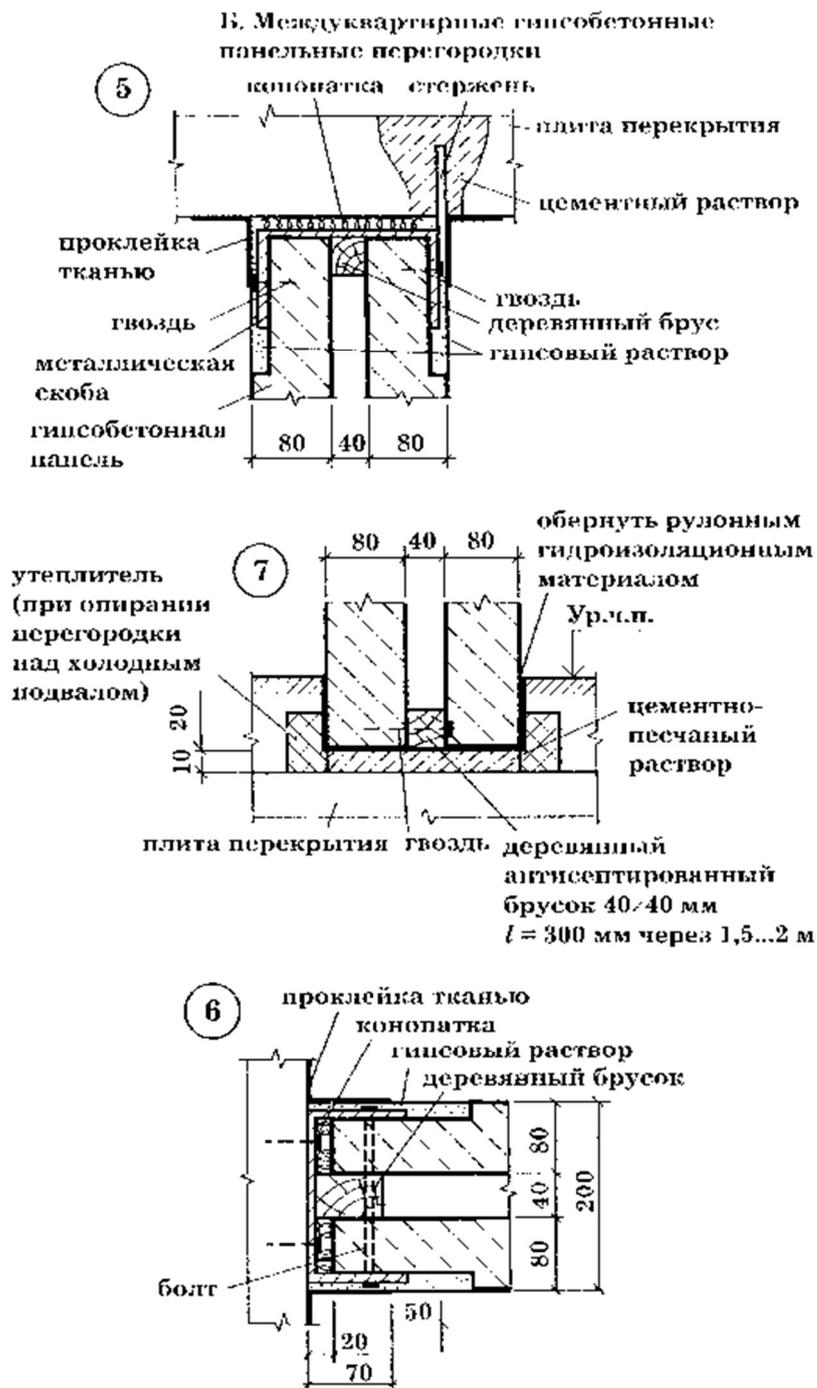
Междуквартирные гипсобетонные перегородки
